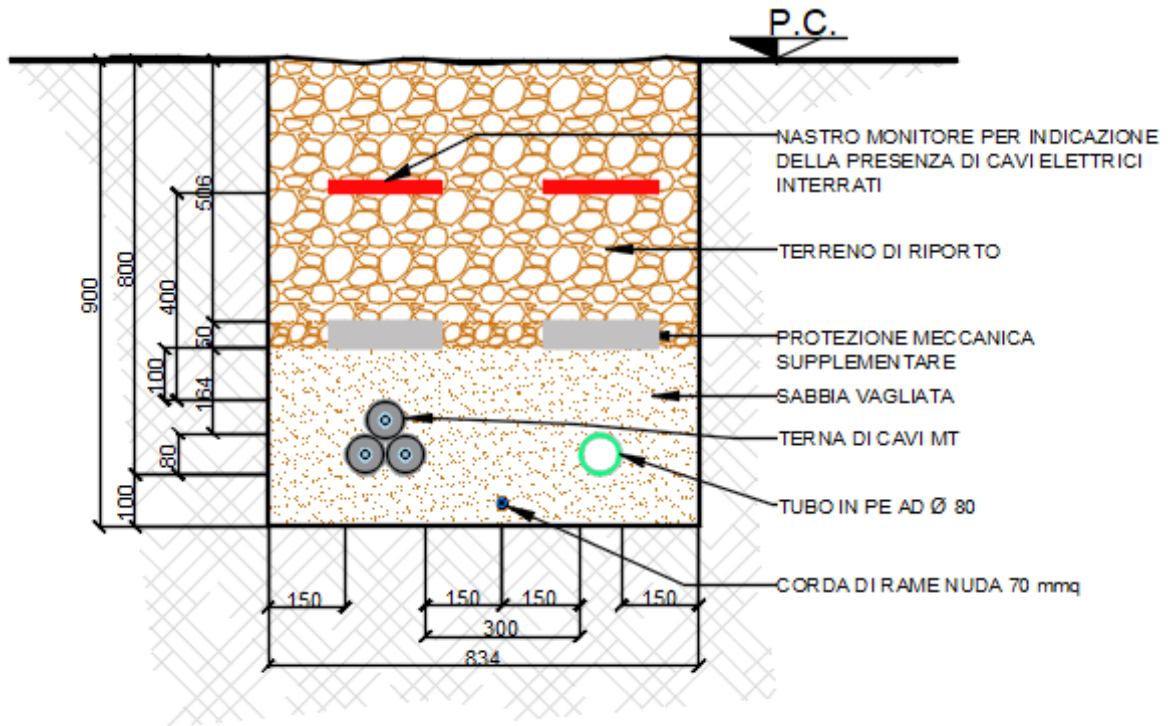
Sezione scavo tipo posa cavidotti (1 terna 30 kV).
